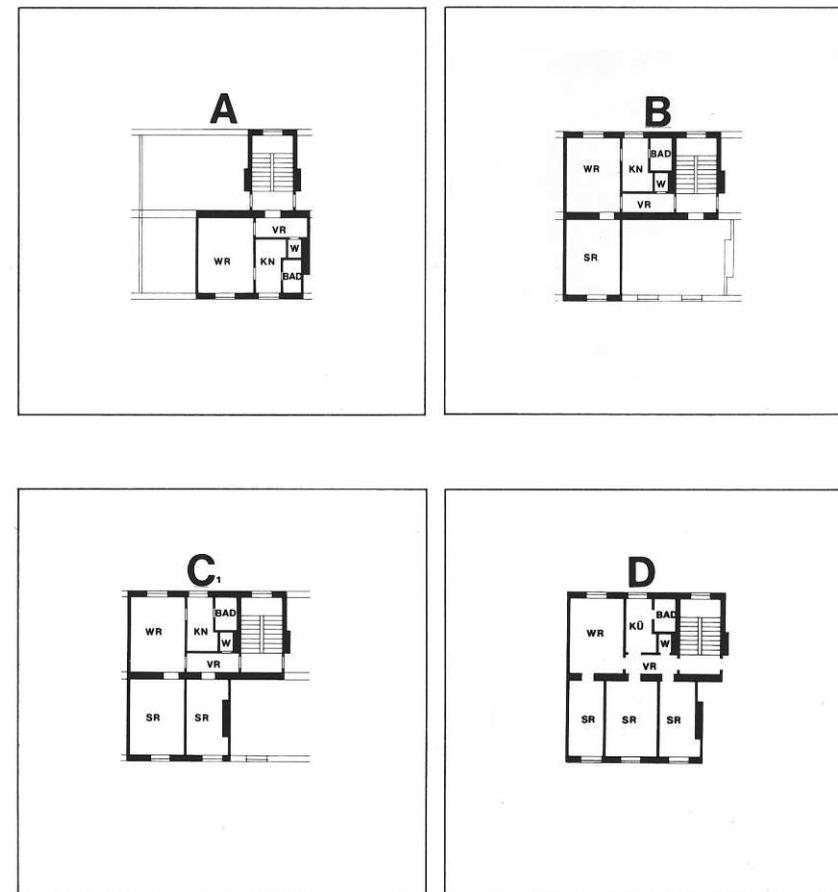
Typengrundrisse der Gemeinde Wien (MA19), 1952-1954
